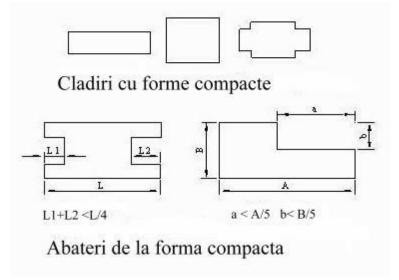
Conditions of structural regularity in the plan Masonry buildings are considered structurally regular in elevation if:
